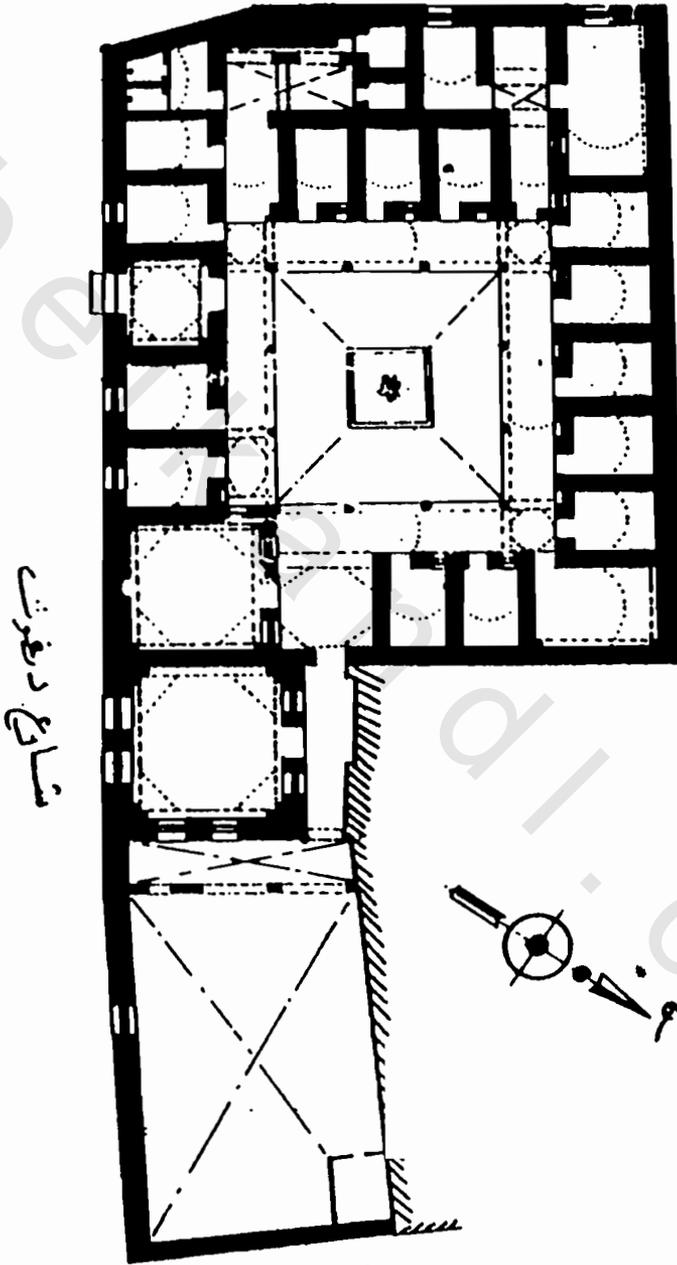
مسقط أفقي لمسجد محمود (١٠٩١هـ/١٦٨٠م)
